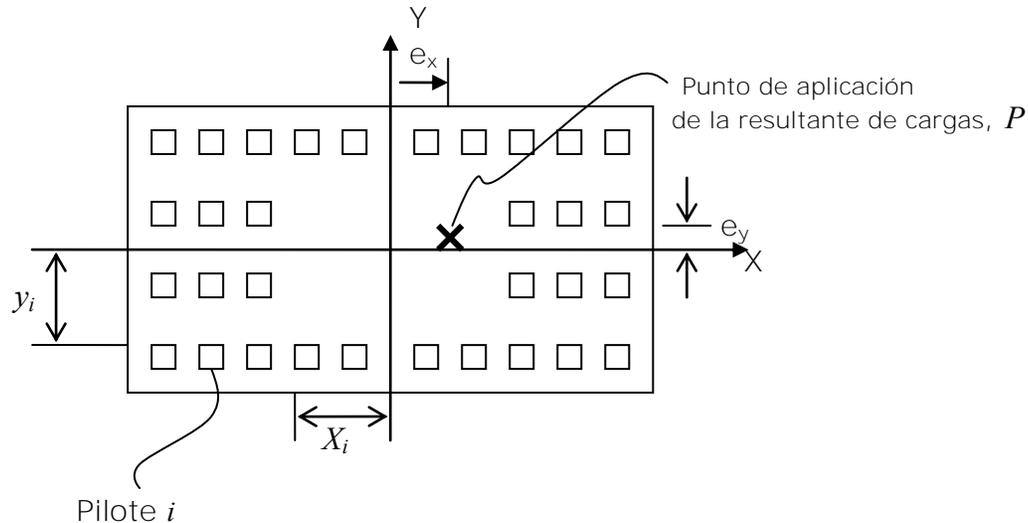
Distribución de cargas en un grupo de pilotes de una zapata de cimentación.
